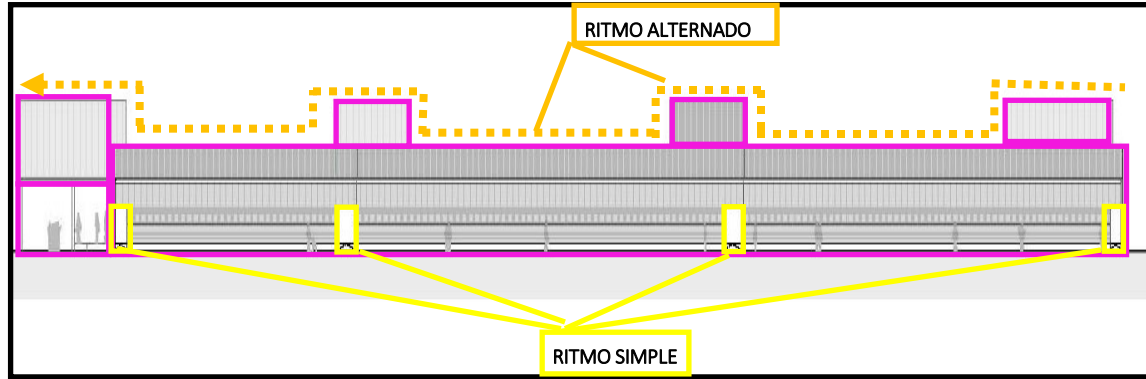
ALZADO DE FACHADAS LATERAL-HOSPITAL PUYO
